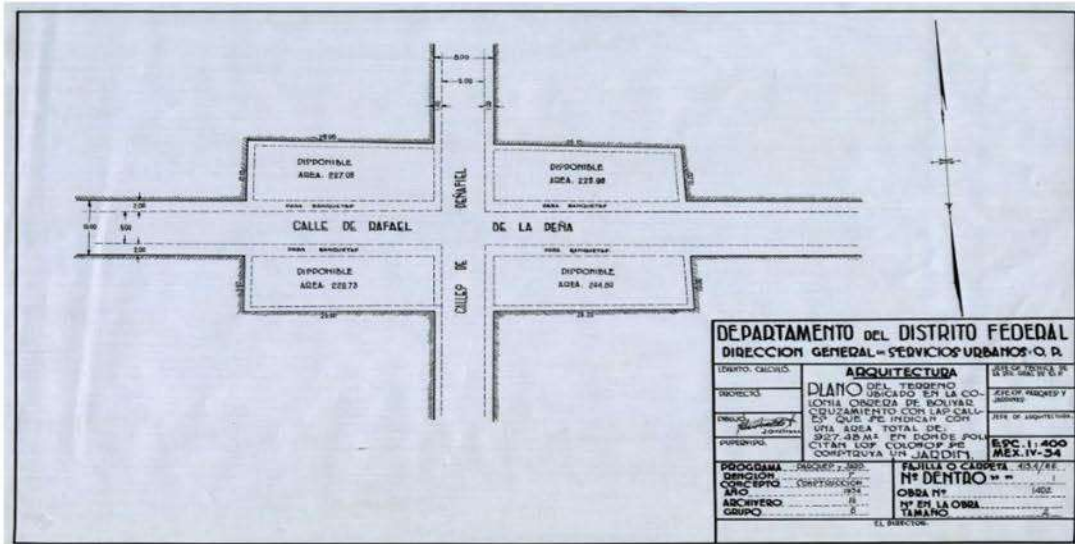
Plano del terreno para la construcción del "Parque Peñafiel".
